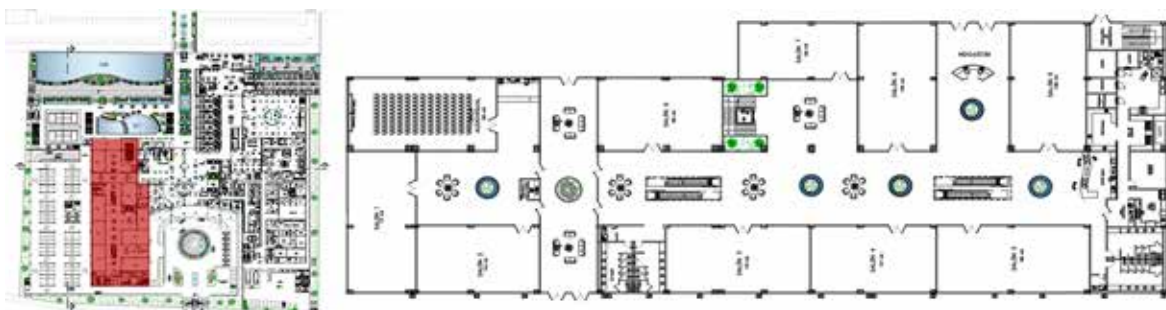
Planta Baja (Centro de Convenciones). (2017).
